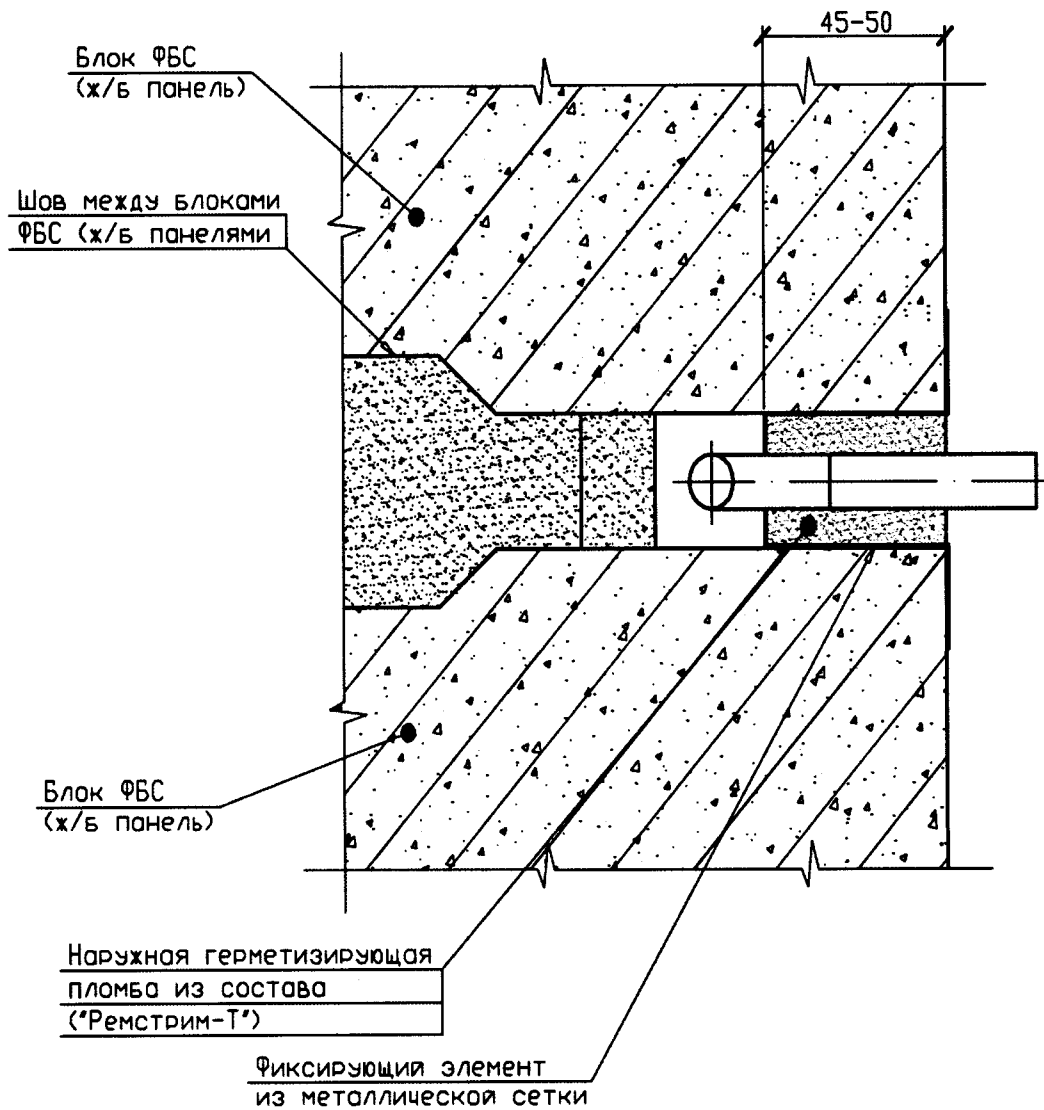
Герметизация между сборными конструкциями (блоками ФБС, ж/б панелями). Устройство наружной герметизирующей пломбы
